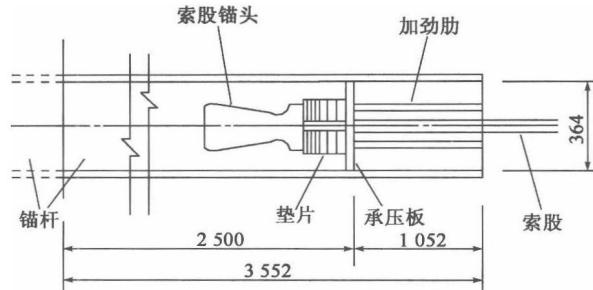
索股锚固连接构造示意(锚固箱式)(尺寸单位:mm)
